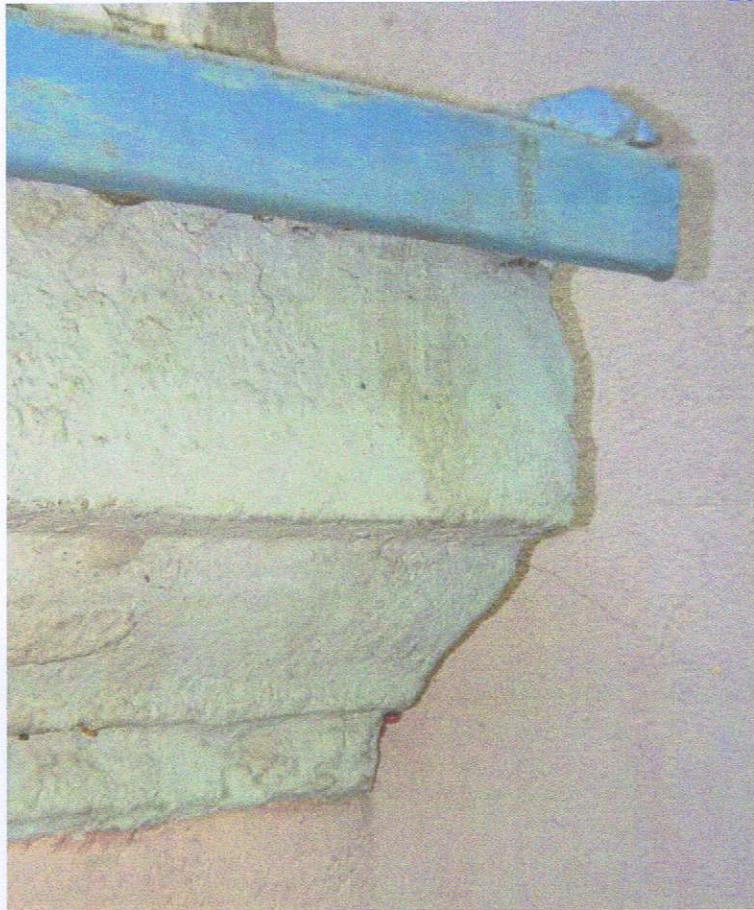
Elewacja wschodnia. Spękane tynki elewacji i detalu nadproża okna
